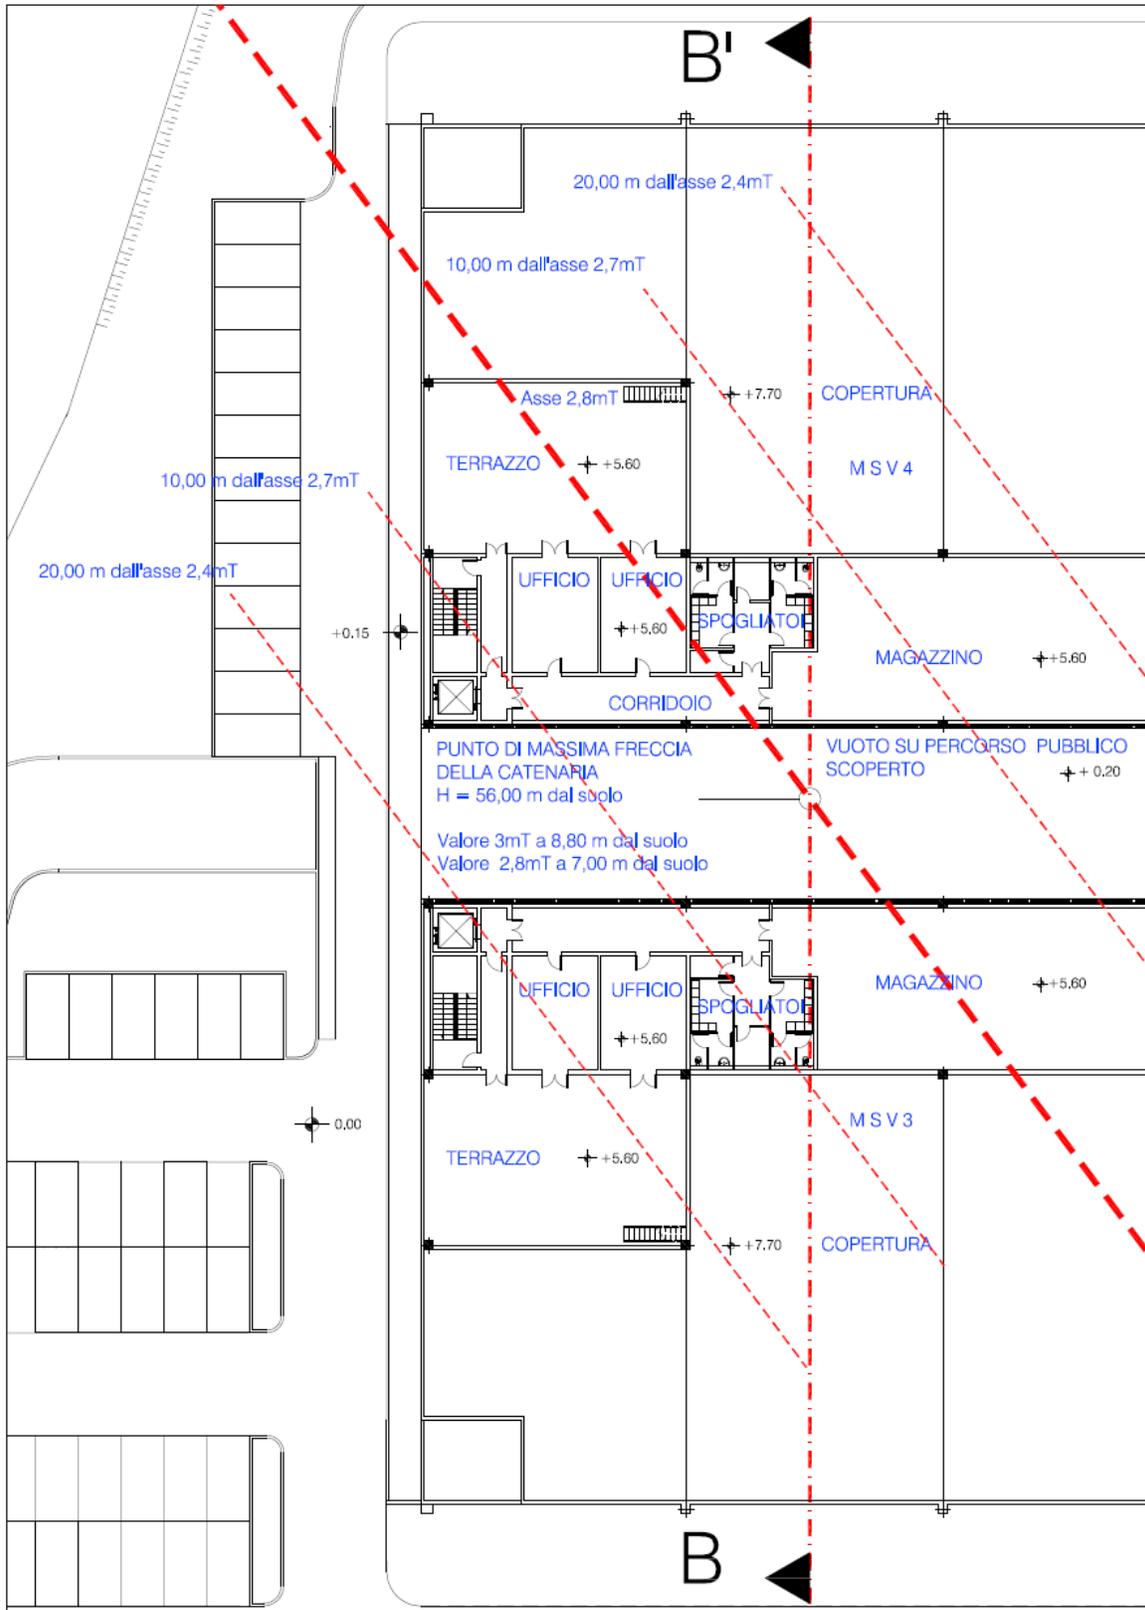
Parco commerciale, planimetria piano primo (stralcio).
